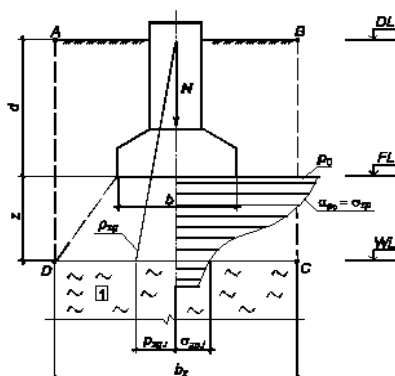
Расчетная схема для проверки прочности слабого подстилающего слоя грунта
